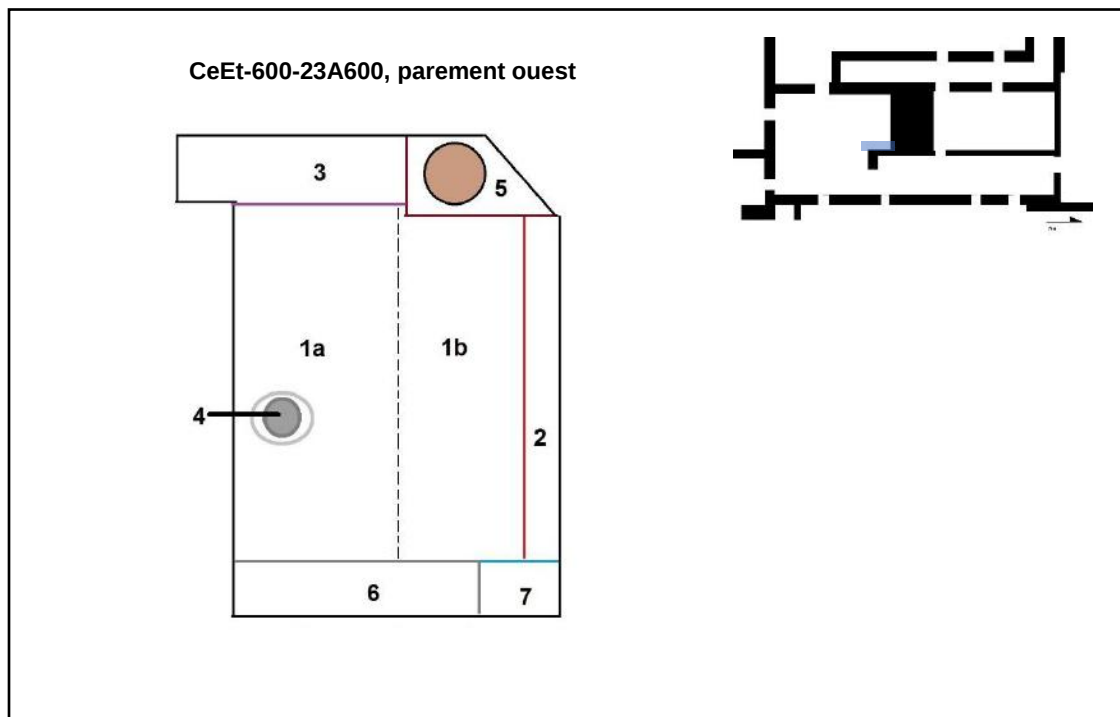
Croquis des modes de construction du mur CeEt-600-23A600, parement ouest.
